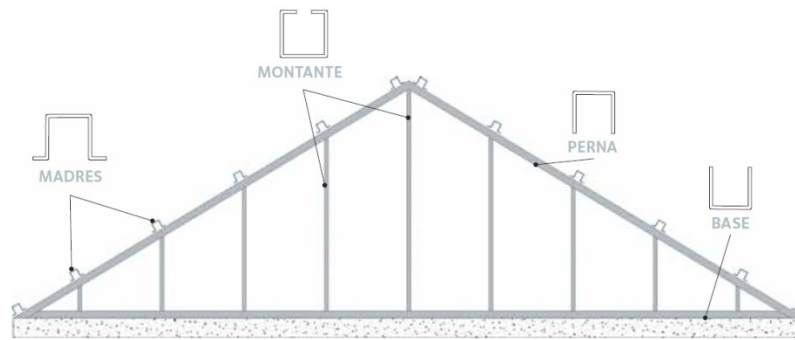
Exemplo de estrutura de asna metálica leve em aço [13].
